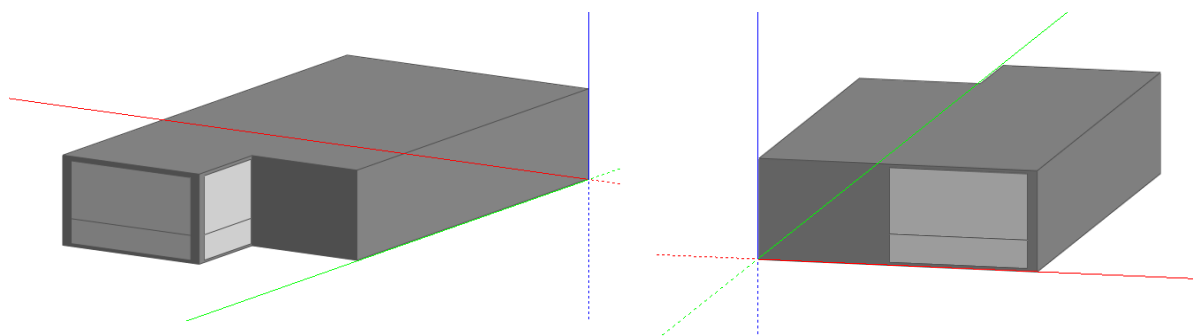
Envidraçado existente nas fachadas Norte (à esquerda) e Sul (à direita) do edifício pastelaria.
